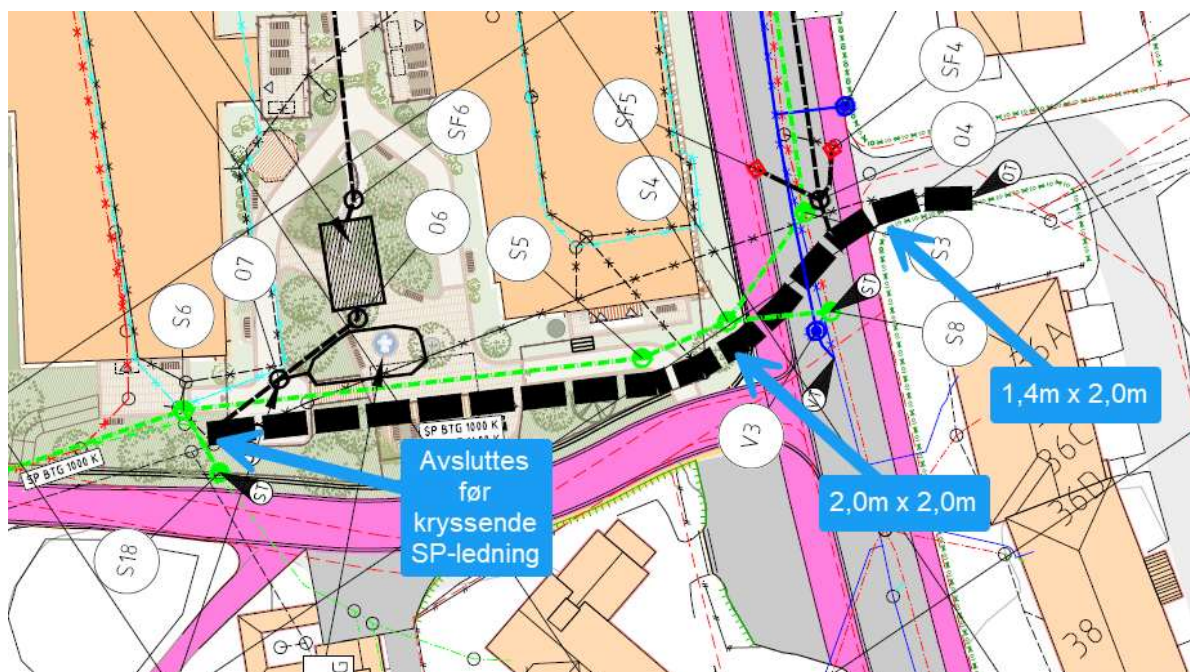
Nedslagsfelt for spillvann som krysser eksisterende kulvert.
